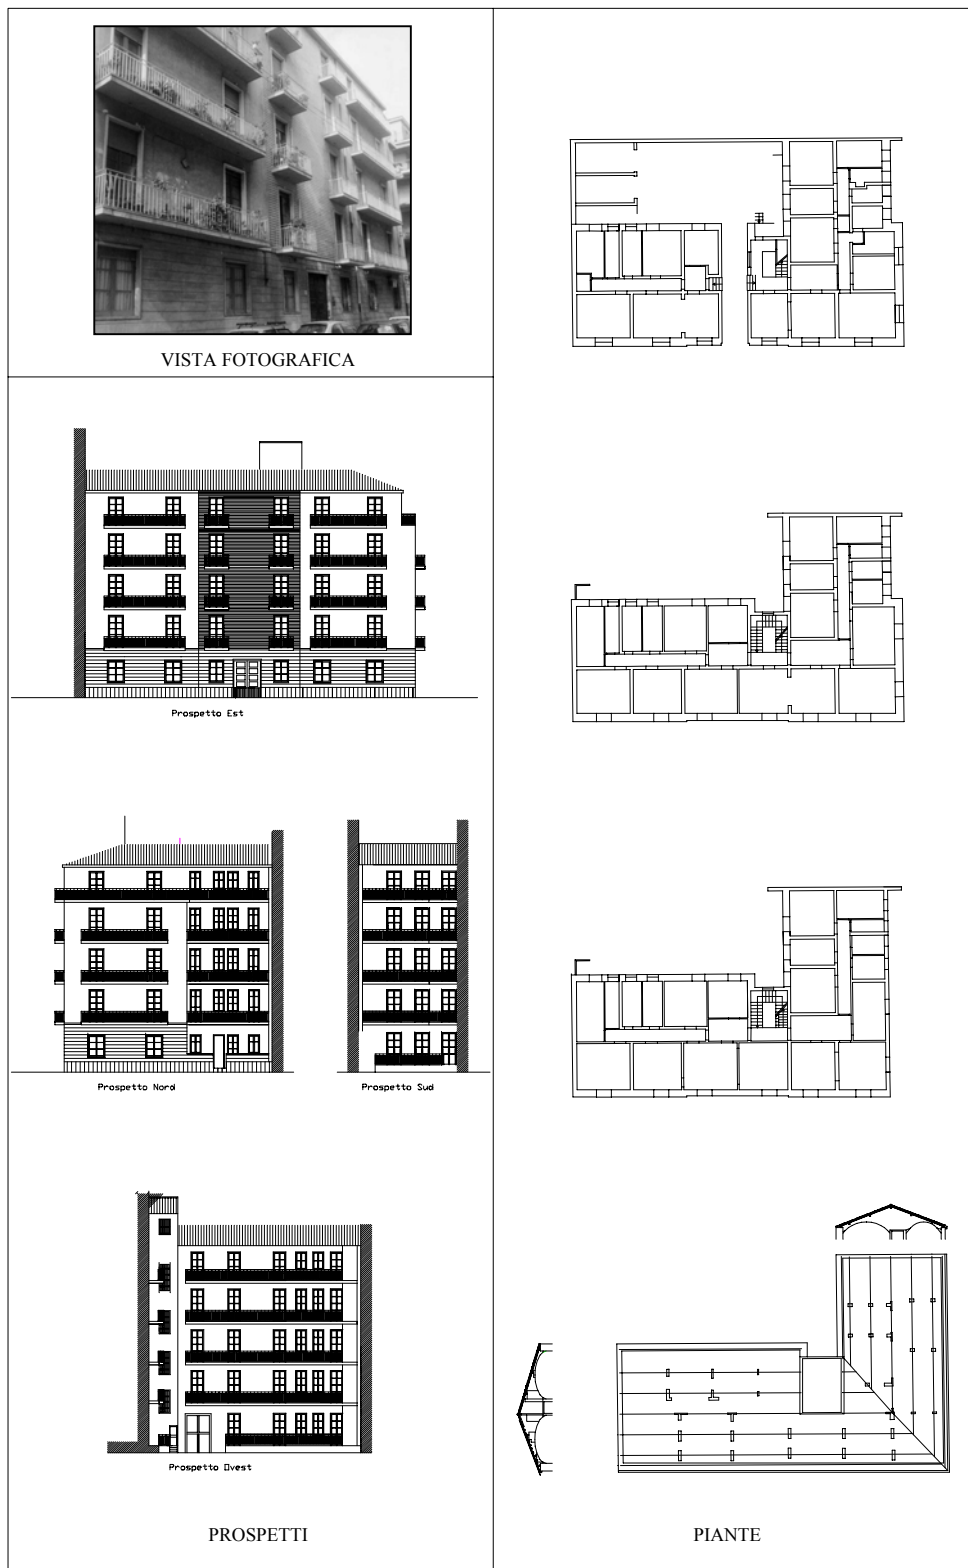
Vista fotografica, piante e prospetti dell'edificio in via Martoglio.
